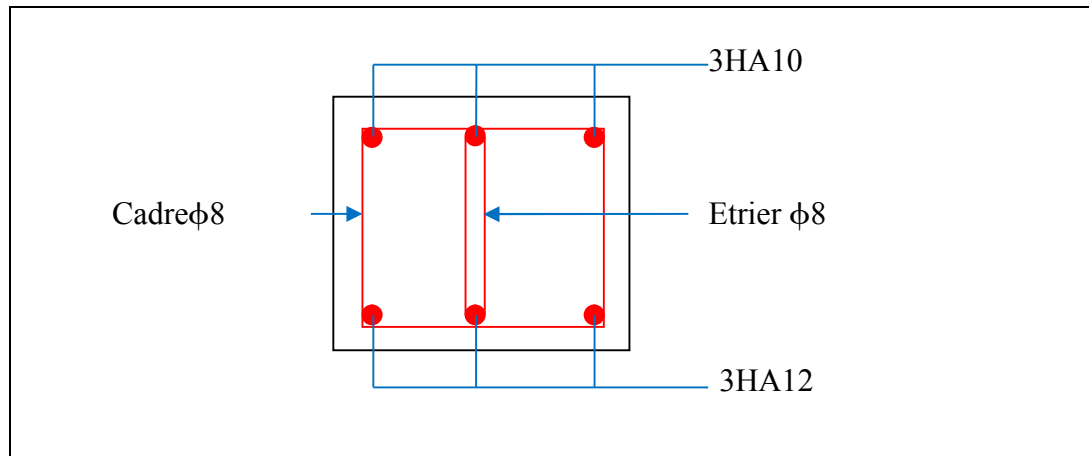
Schéma de ferrailage de la poutre de chaînage.
